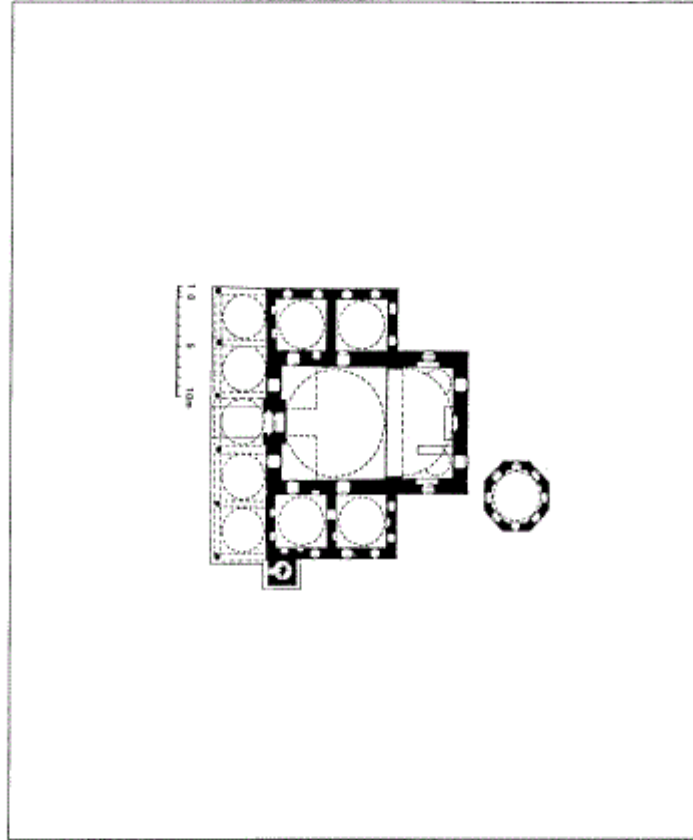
مكرر) مسقط أفقي لمسجد بايزيد بلديم أو مسجد خداوند كار في أدرنة (عن :
